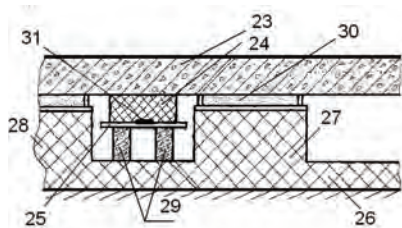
Схема виброизоляции железобетонной плиты в основании здания.
